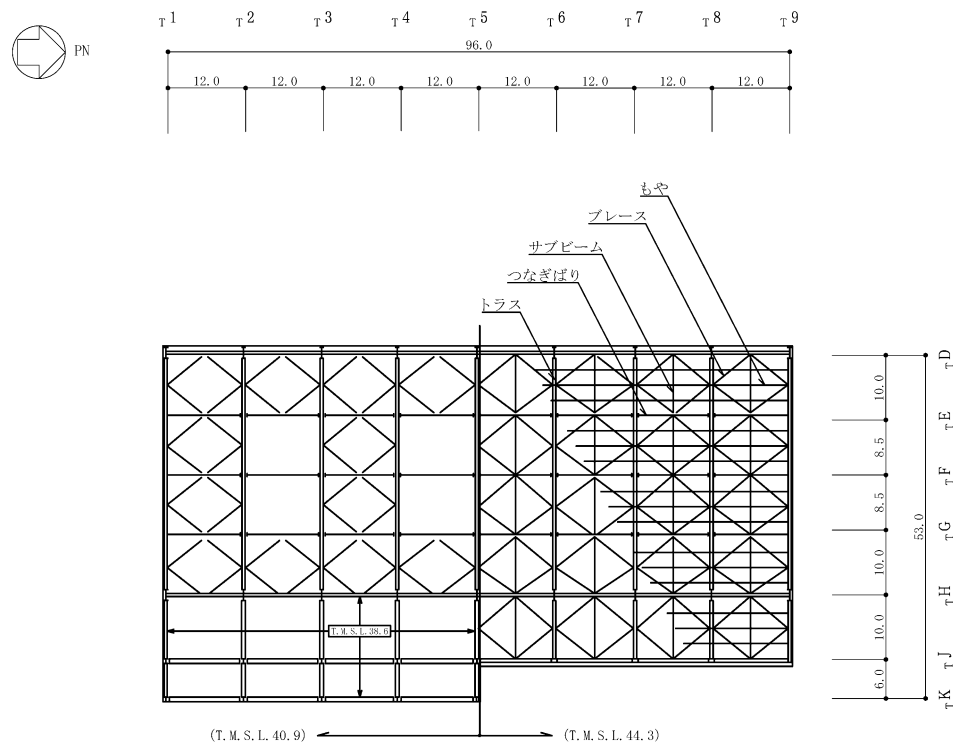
タービン建屋の概略平面図 (RF, T.M.S.L. 44.3m) (6/6) (単位 : m)
